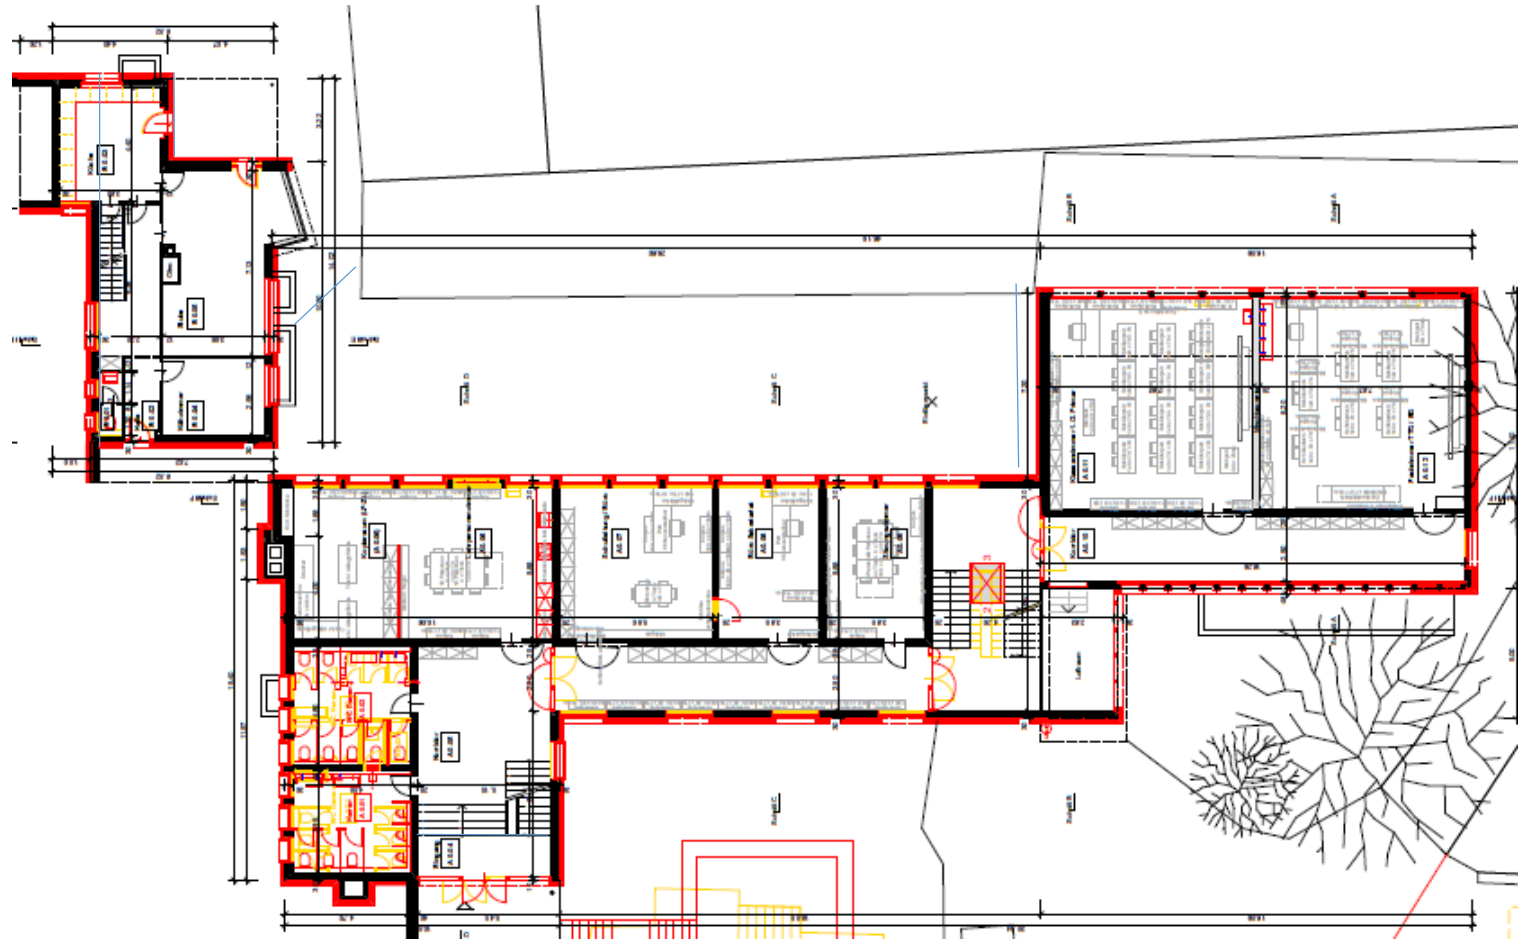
Grundriss 1. Untergeschoss mit den geplanten Massnahmen
